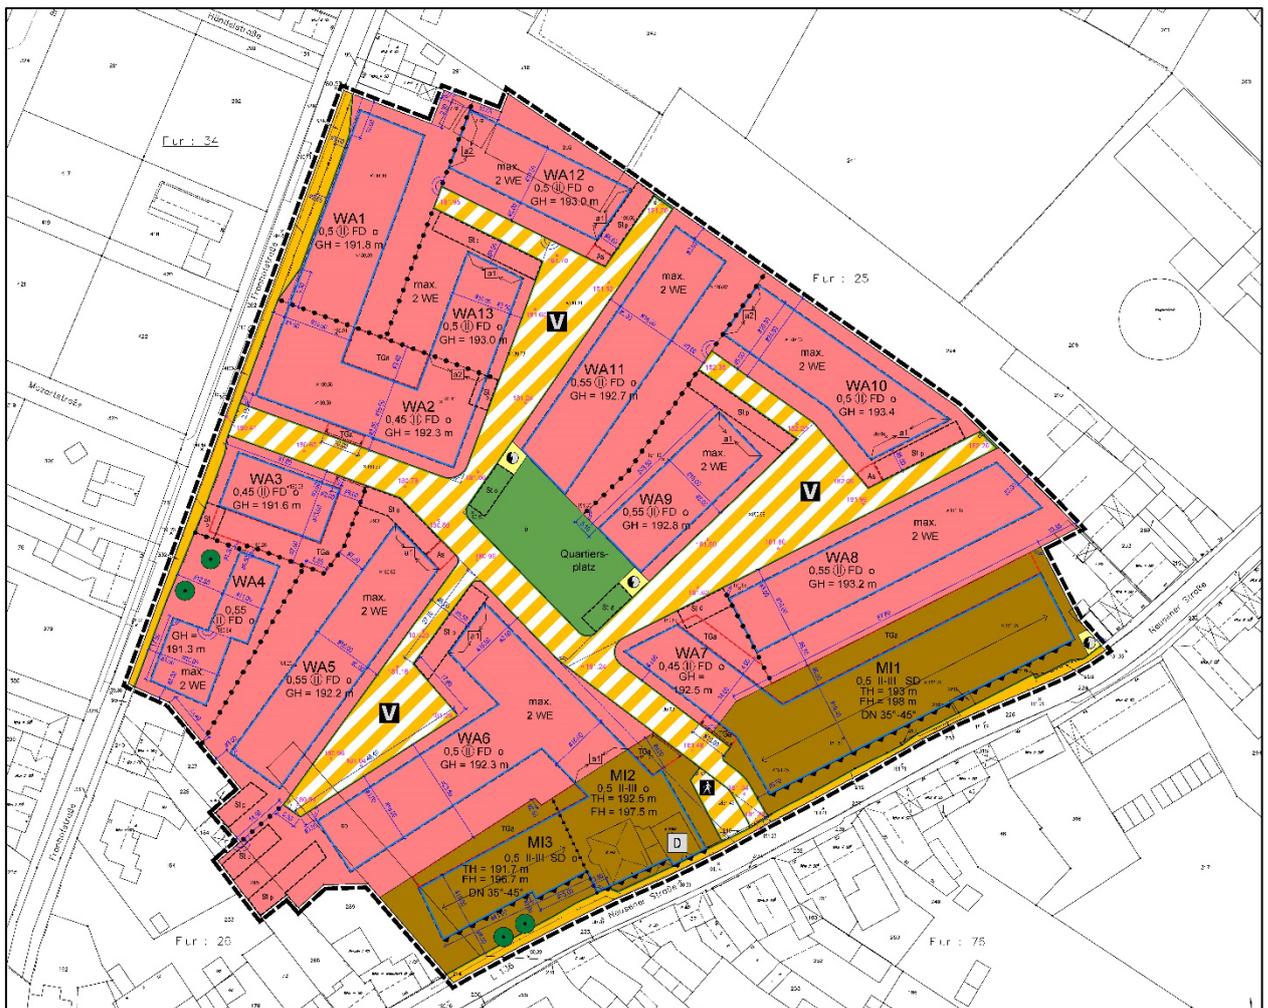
Planzeichnung des Bebauungsplans Entwurf
